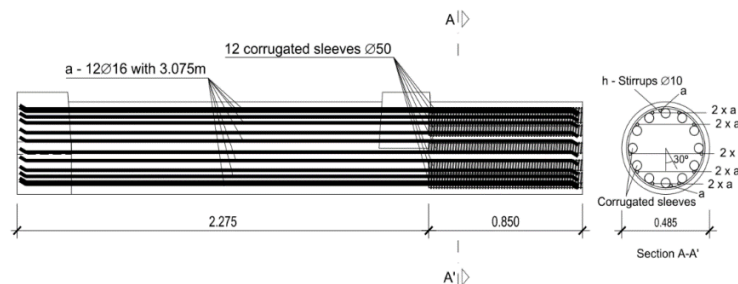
Armadura longitudinal do elemento A do modelo com ligações de barras salientes (modelo S3).
